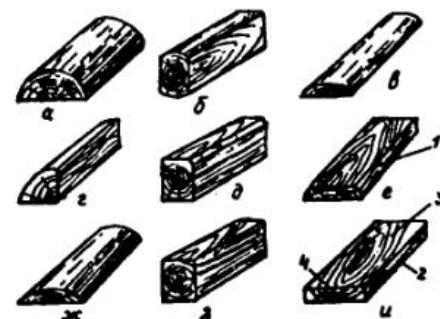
Виды пиломатериалов: а — пластина; б — двухкантовый брус; в — необрезная доска; г — четвертьина; д — четырехкантовый брус с обзолом; е — полуобрезная доска с обзолом; ж — горбыль; з — чистообрезной брус; и — обрезная доска. 1 — обзол; 2 — ребро; 3 — пласти; 4 — торец.
